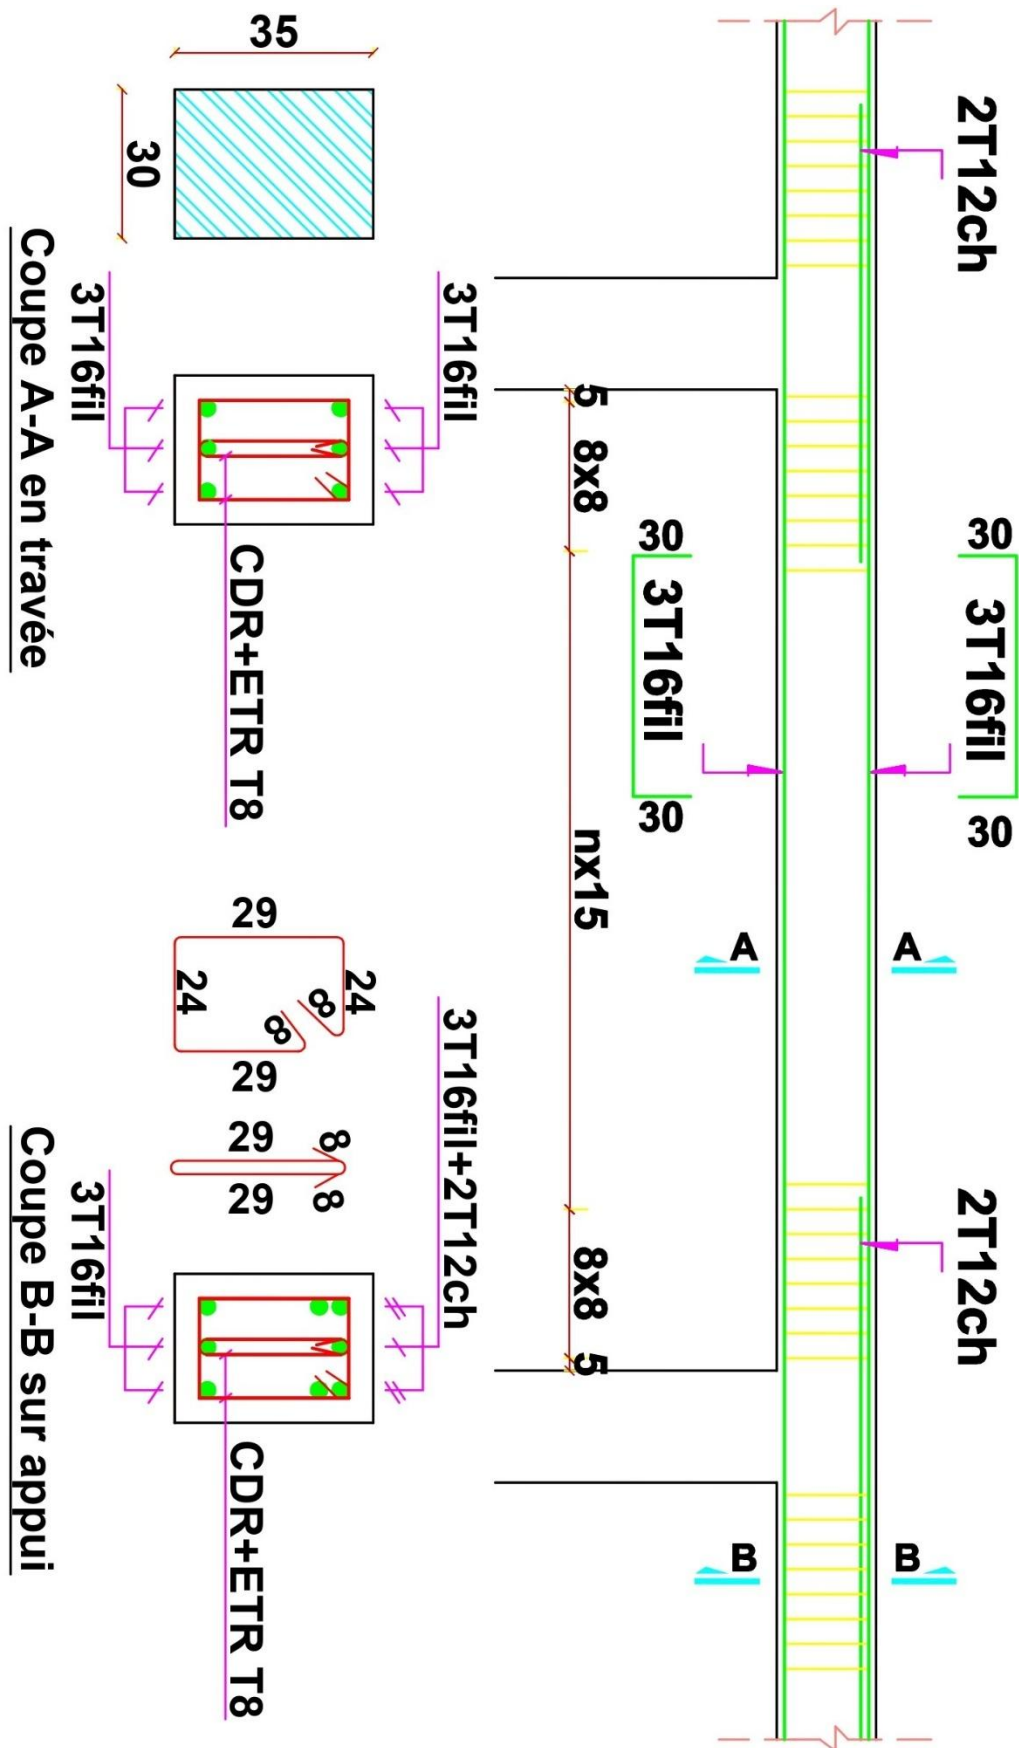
Schéma de ferrailage des poutres secondaires
